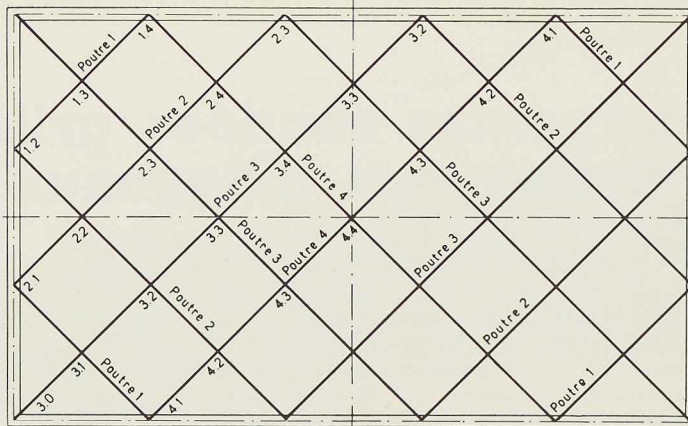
Plan type d'une charpente plane grillagée à éléments diagonaux.
